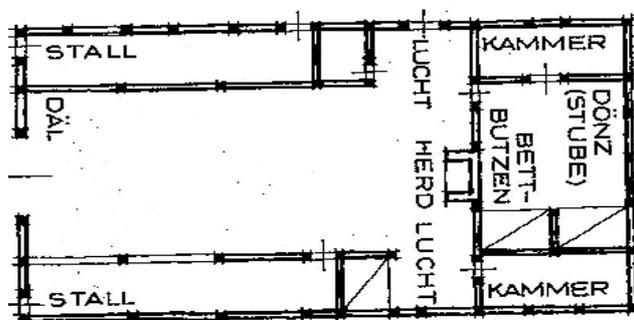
Grundriss eines Hallenhauses (aus: Meibeyer, 2005)
